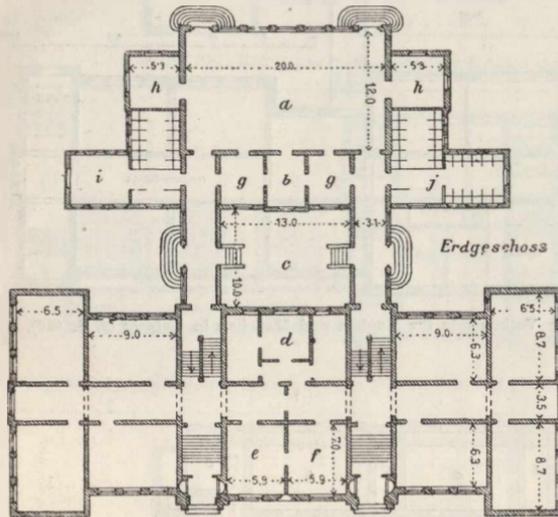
Grundriß einer Volksschule in Jena, Erdgesch. (s. S. 652).
